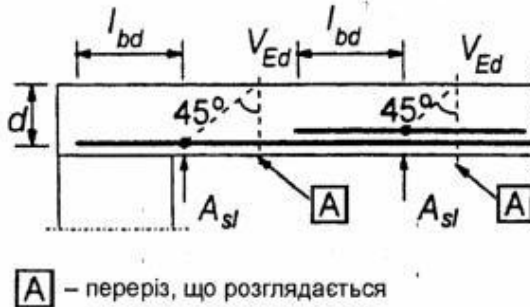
Визначення розрахункового перерізу по довжині балки при розрахунку на поперечну силу
